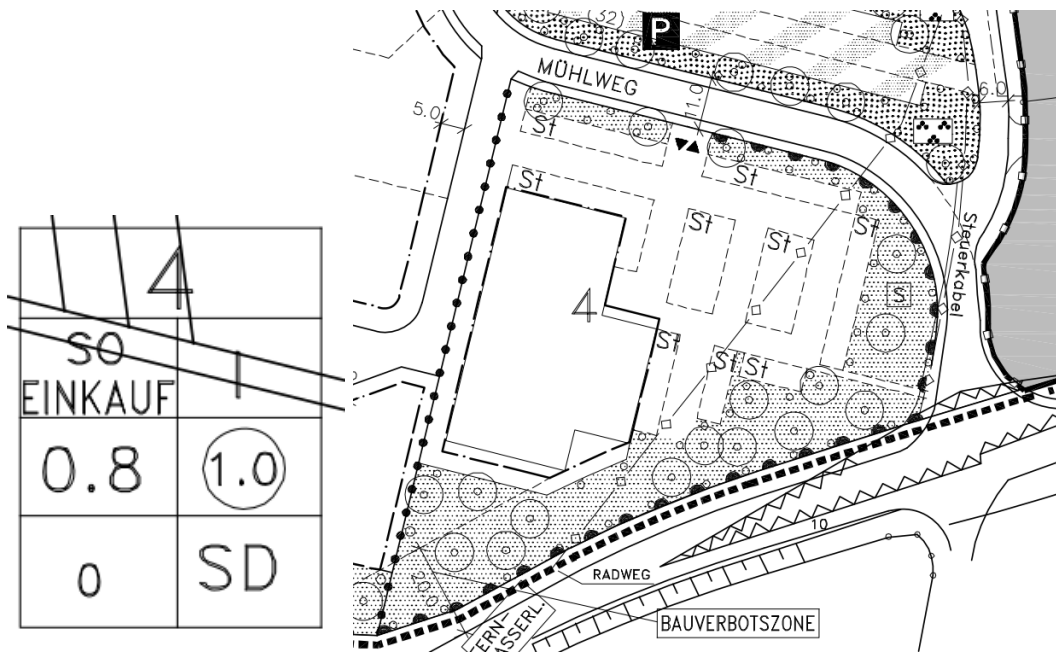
Auszug aus dem Bebauungsplan 9A „Mühlweg“ 4. Änderung mit dem Maßgeblichen Geltungsbereich der 5. Änderung
